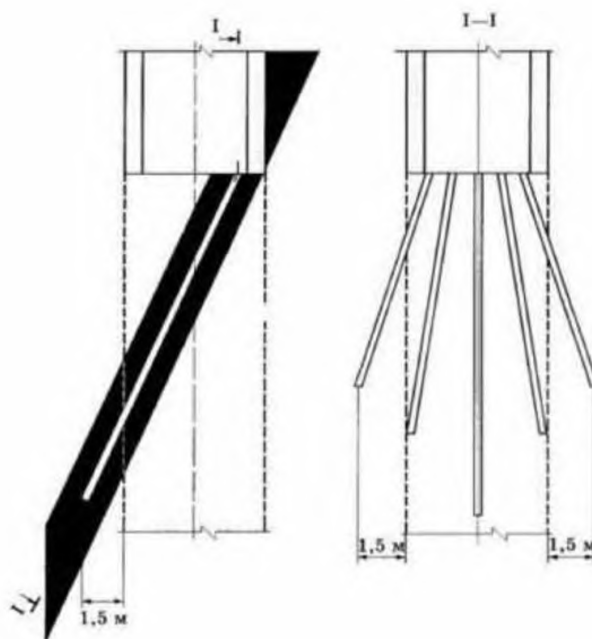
Схема расположения дренажных скважин при пересечении угольных пластов крутого залегания
